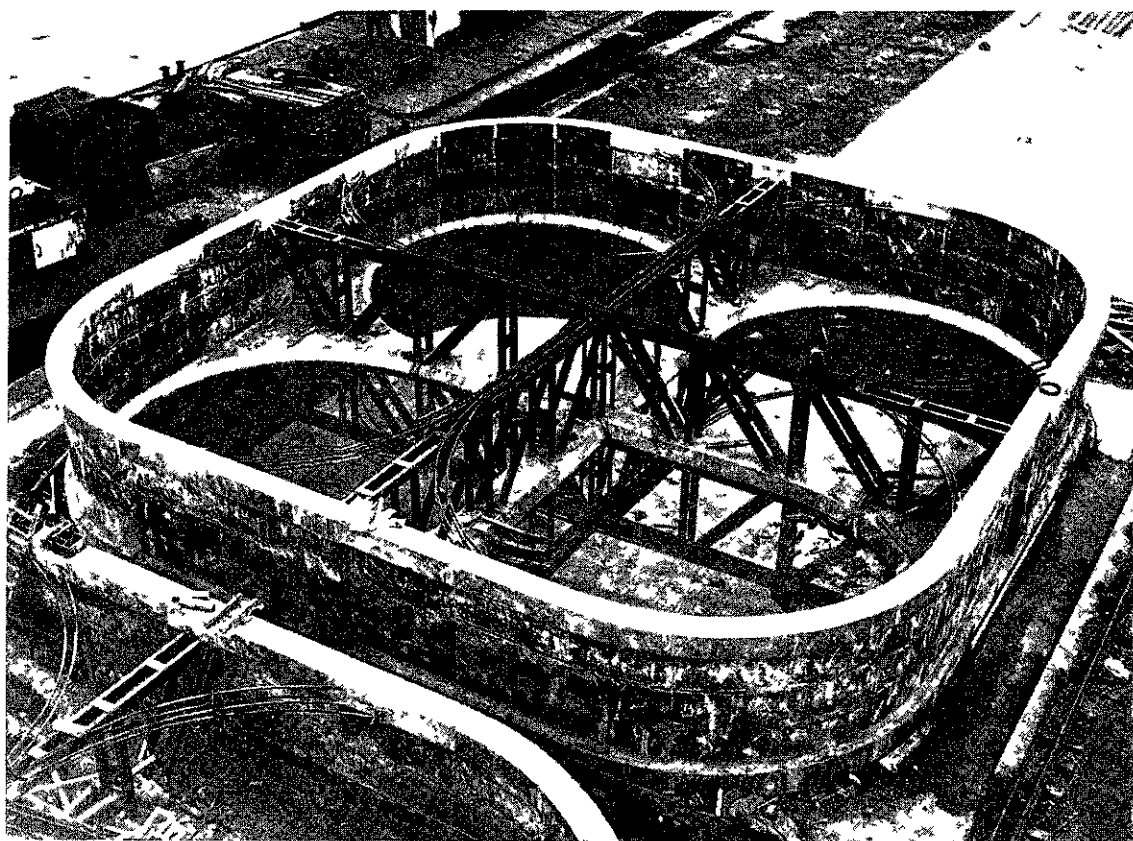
Port de Lavéra : Chantier de construction à Marseille :
